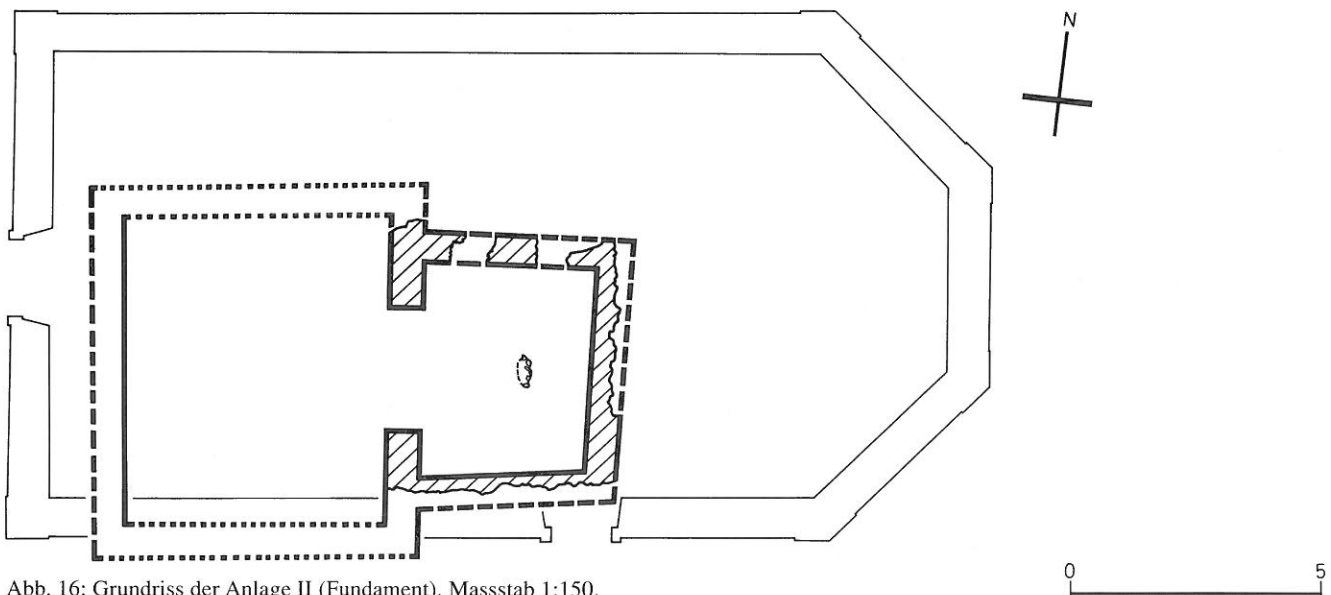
Grundriss der Anlage II (Fundament). Massstab 1:150.
